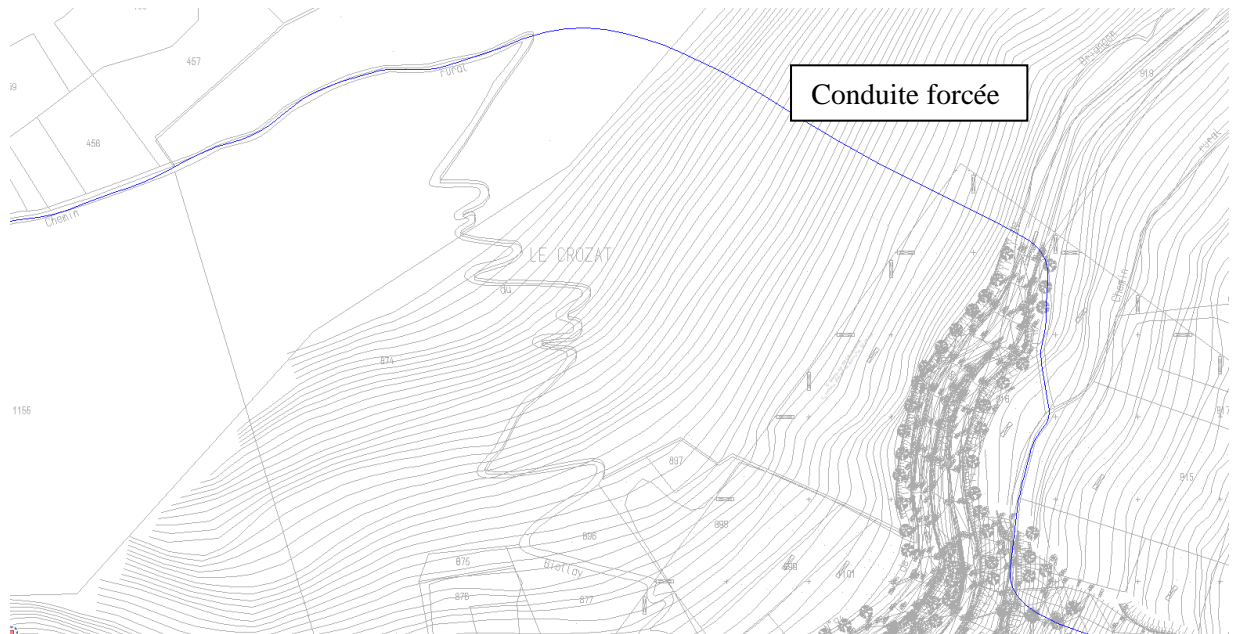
Implantation conduite forcée sur fond cadastral (5)
